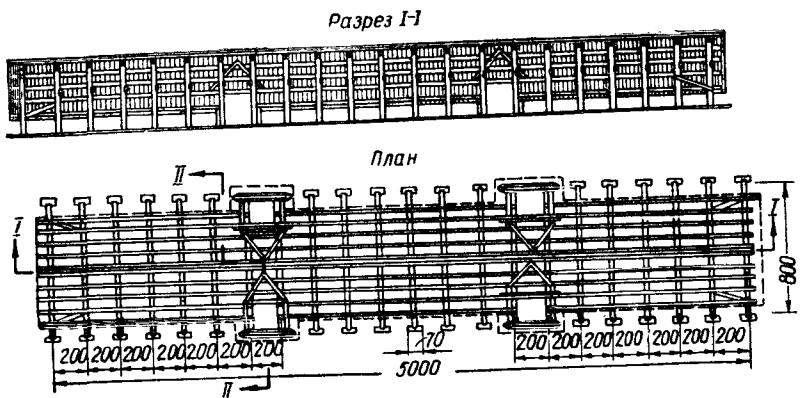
Бесстеллажный шатровый сарай. Разрез I—I и план
